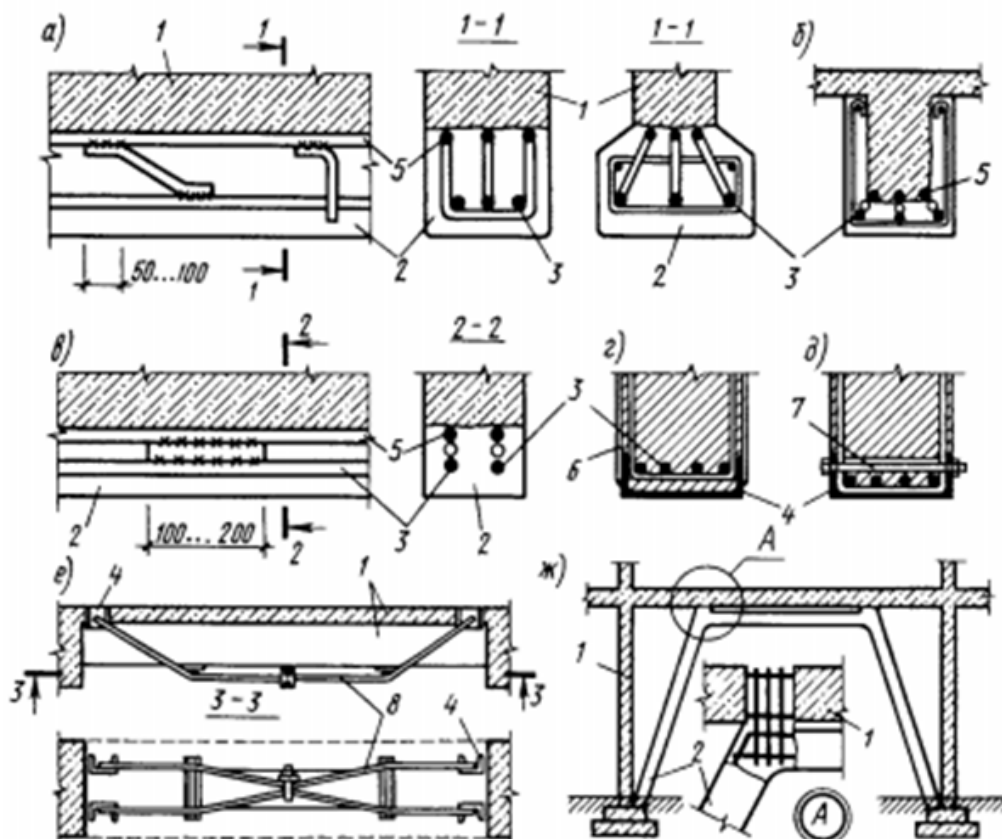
Підсилення залізобетонних балок нарощуванням знизу (а,б,в), застосуванням зовнішньої арматури(г, д) і зміною конструктивної схеми (е, ж):
